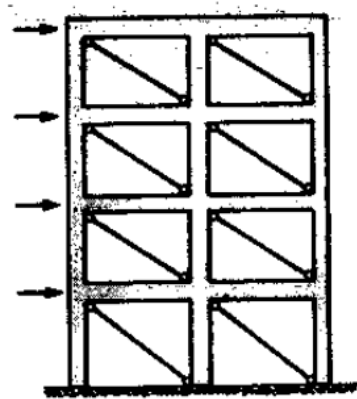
Representación de los muros de albañilería en un pórtico.
